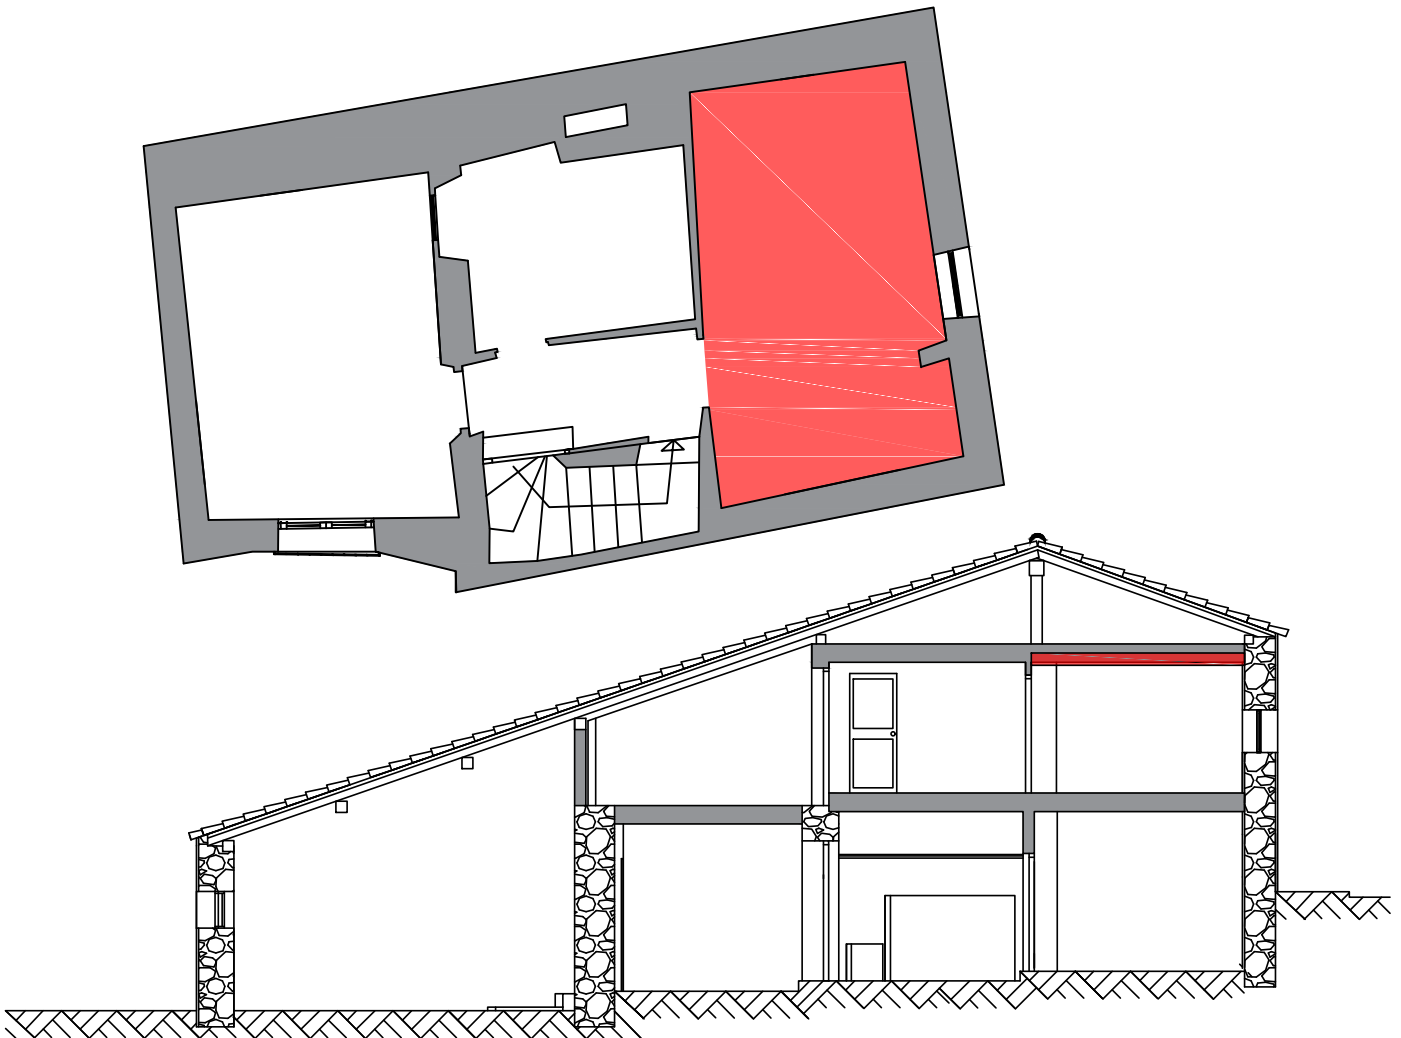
Fisuras en parte inferior de forjado. Fuente propia.
